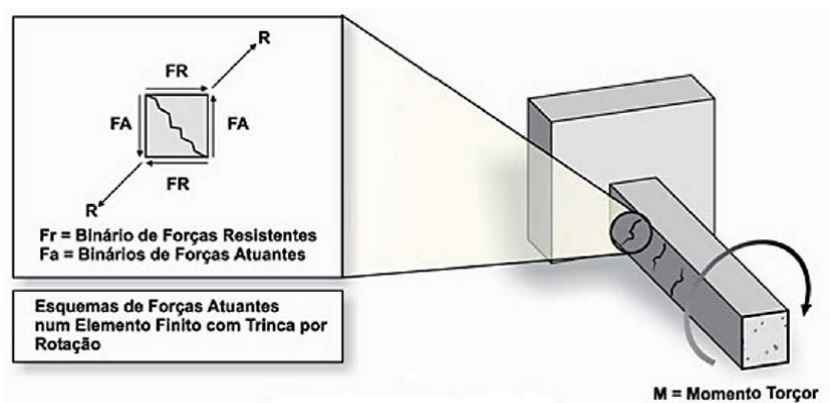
Fissura causada por esforço de torção em uma viga.
